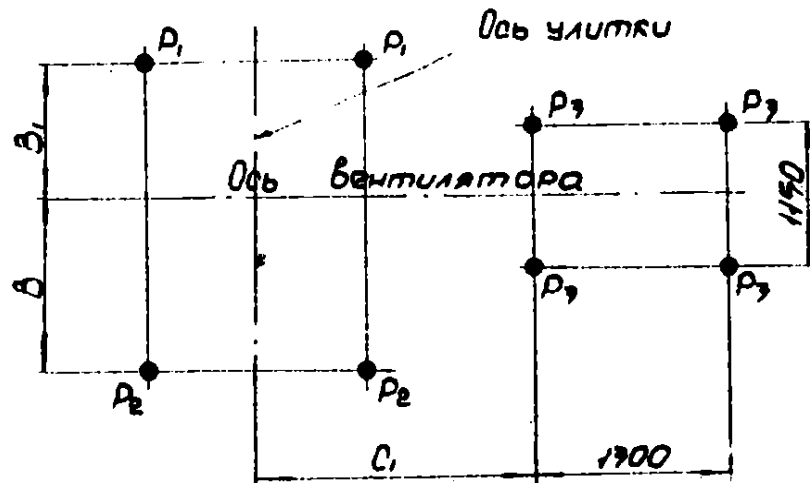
Схема распределения нагрузки на опоры от дутьевых вентиляторов типа ВДН-22П, ВДН-24П, ВДН-26П
